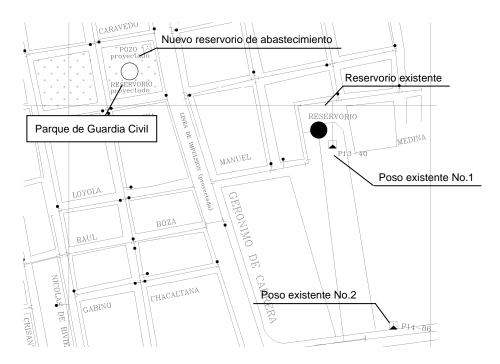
Ubicación de las instalaciones existentes y las planeadas
